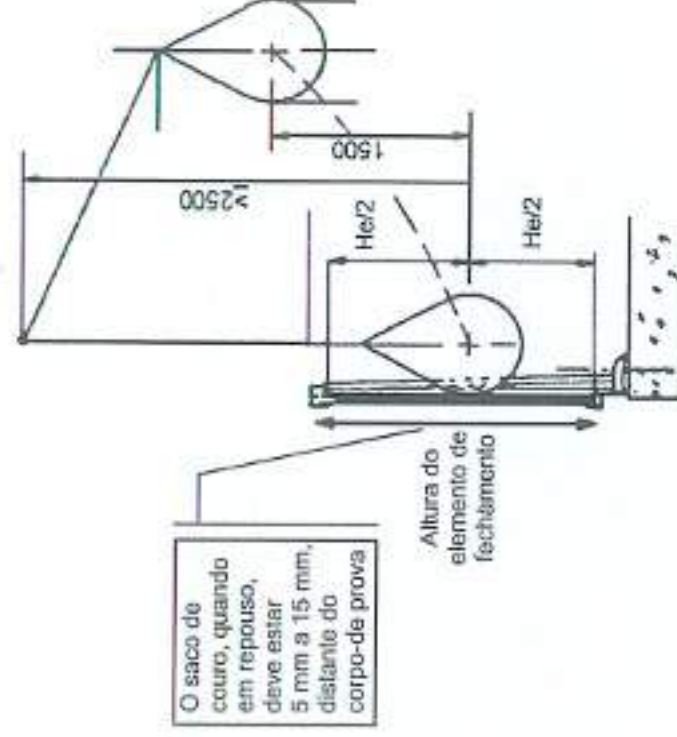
Esquema de aplicação do impacto do impacto sobre elementos de fechamento de guarda-corpos
